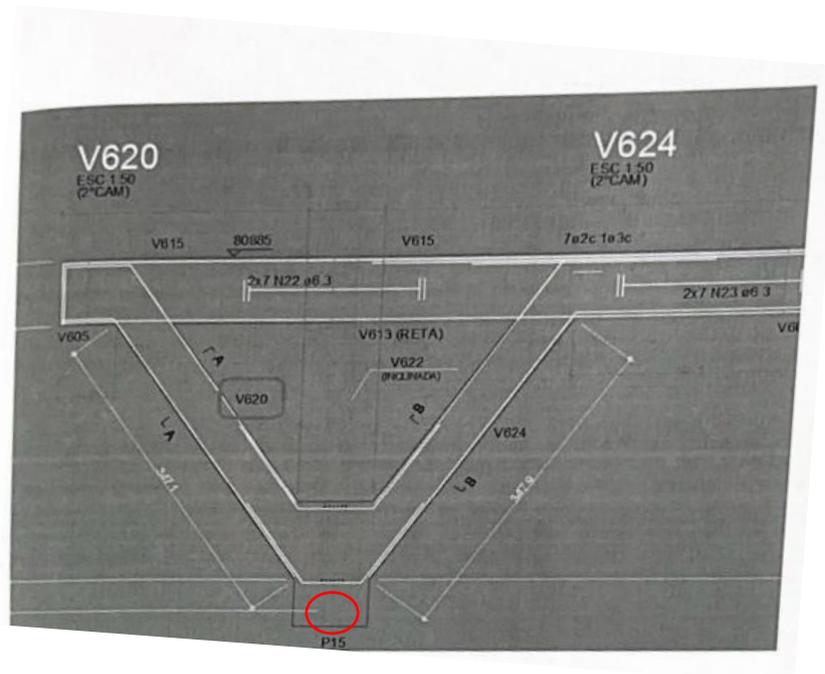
Forma das vigas e lajes (1º pavimento)
